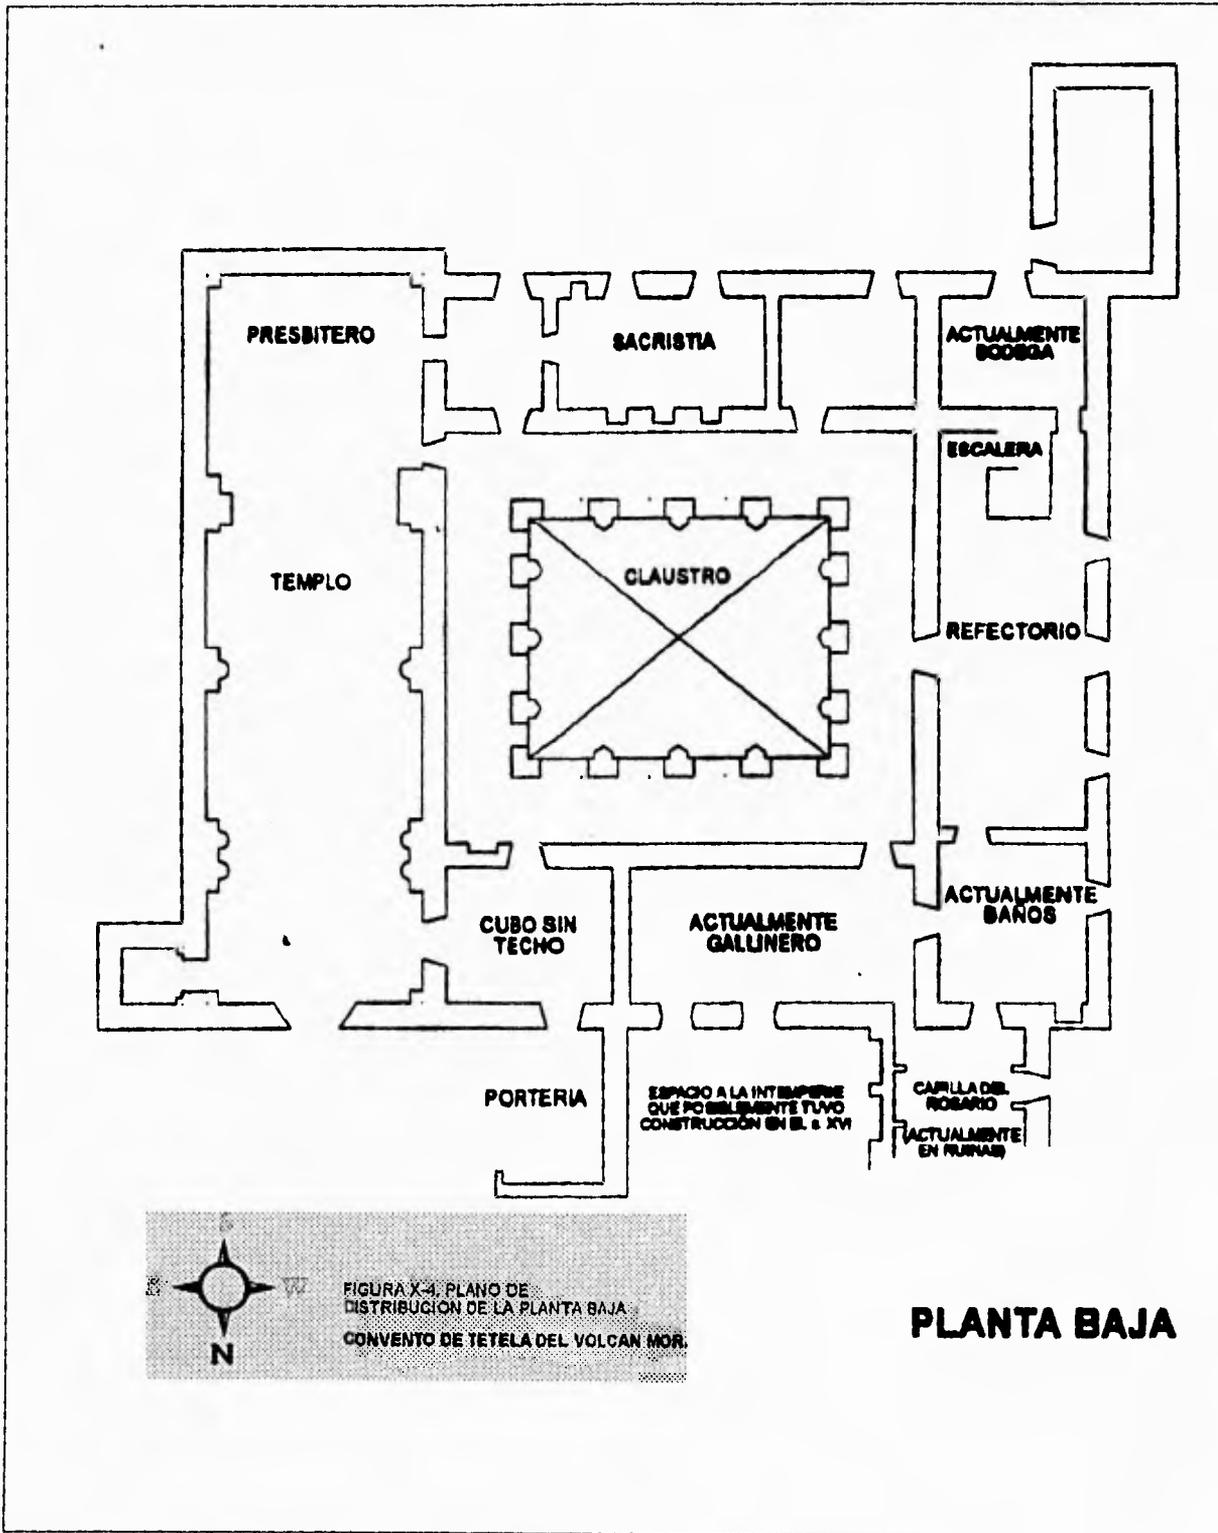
Plano de la planta baja del convento de Tetela del Volcán.
